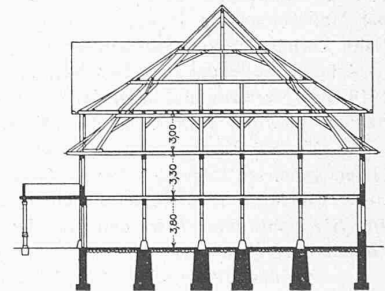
bis 6. Erdgeschoss-Grundriss, Teilgrundrisse vom 1. und 2. Stock und Schnitt des Zeughauses in Herisau. — Masstab 1:500,
